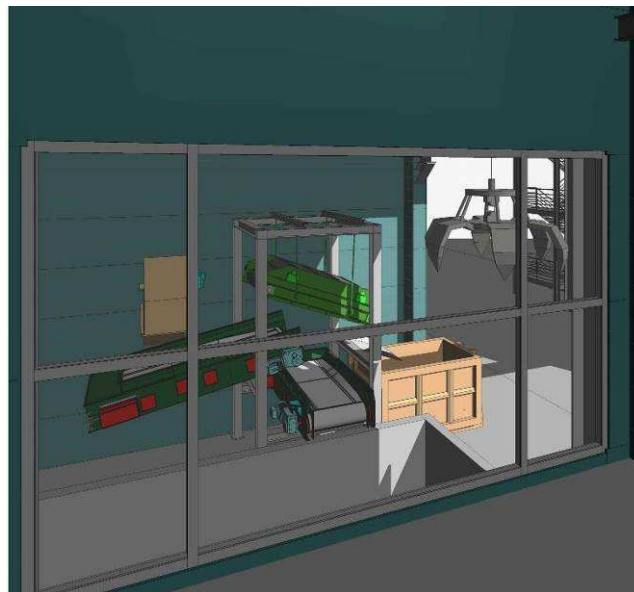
Dettaglio locale gruista, lato cabina, con vetri antisfondamento e di sicurezza dalla fossa scorie
